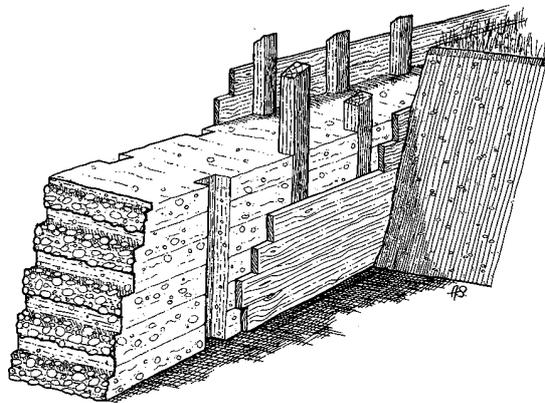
Detalhe de fôrma de madeira utilizada em construções romanas
